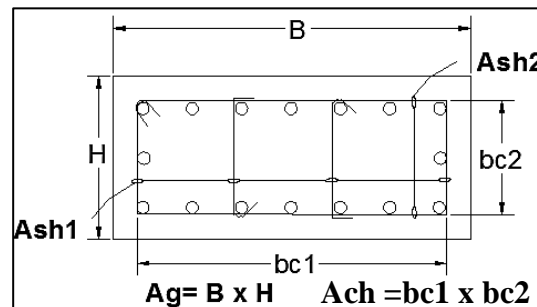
Separación volumétrica de los estribos cerrados de confinamiento.
